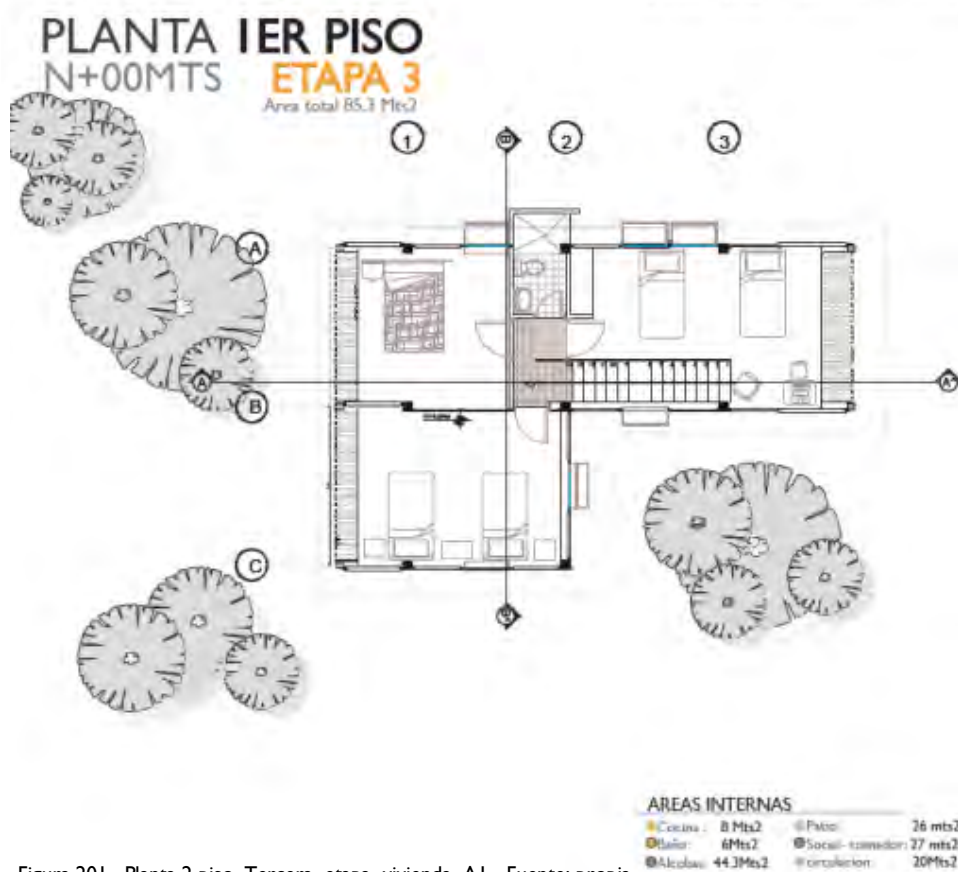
Planta 2 piso, Tercera etapa vivienda A1 Fuente: propia
